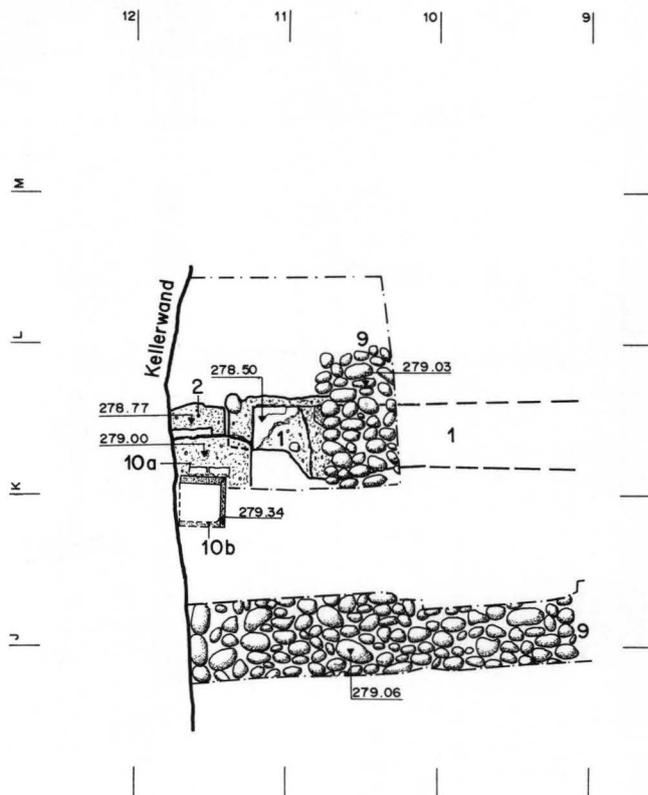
Alte Landvogtei, Grundriss (Flächen 1, 1a und Sondierschnitte I–VI). – Umzeichnung H. Eichin, nach Vorlage von Ch. Stegmüller. – Massstab 1:50.
